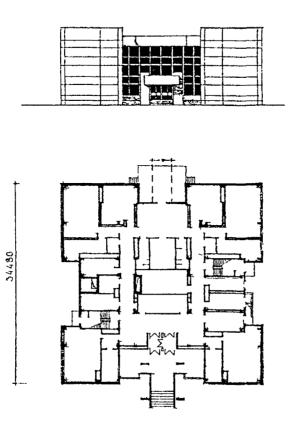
Проект блока-пристройки эстегического воспитания на 480 учащихся V-80 (разработан в 1982 году). Фасад и план первого этажа.
